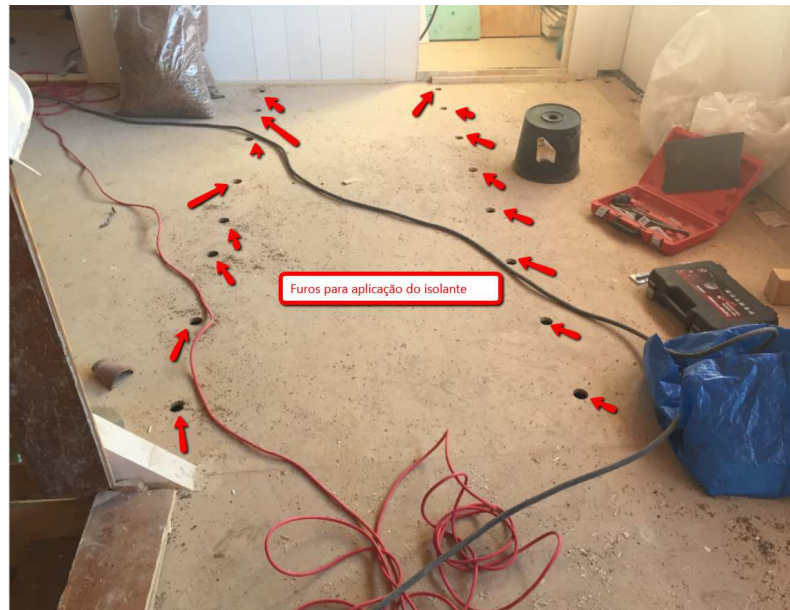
Furação para aplicação do isolante em pavimento a revestir com soalho
